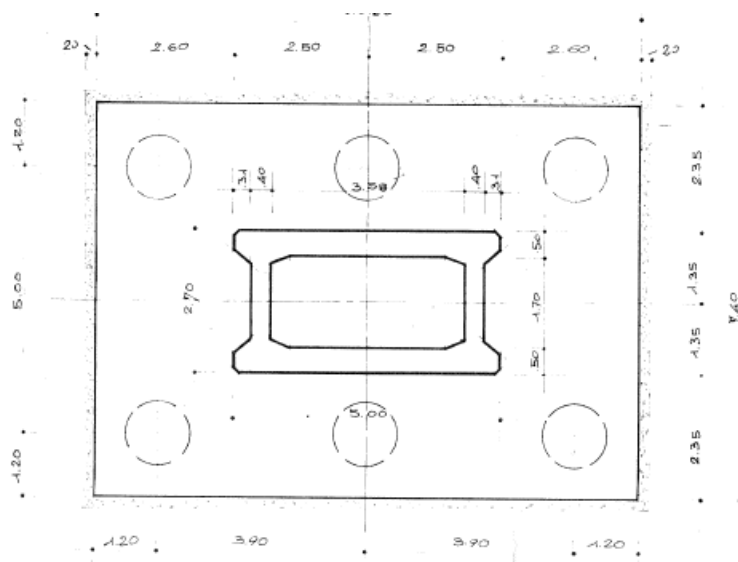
Pianta della fondazione con indicazione dei pali, 6 pali
